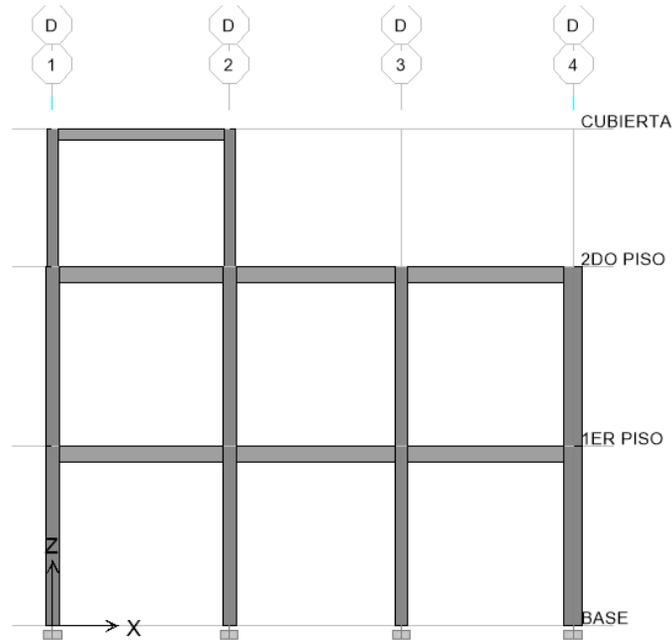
; Pórtico Eje D. Del diseño estructural de hormigón armado
